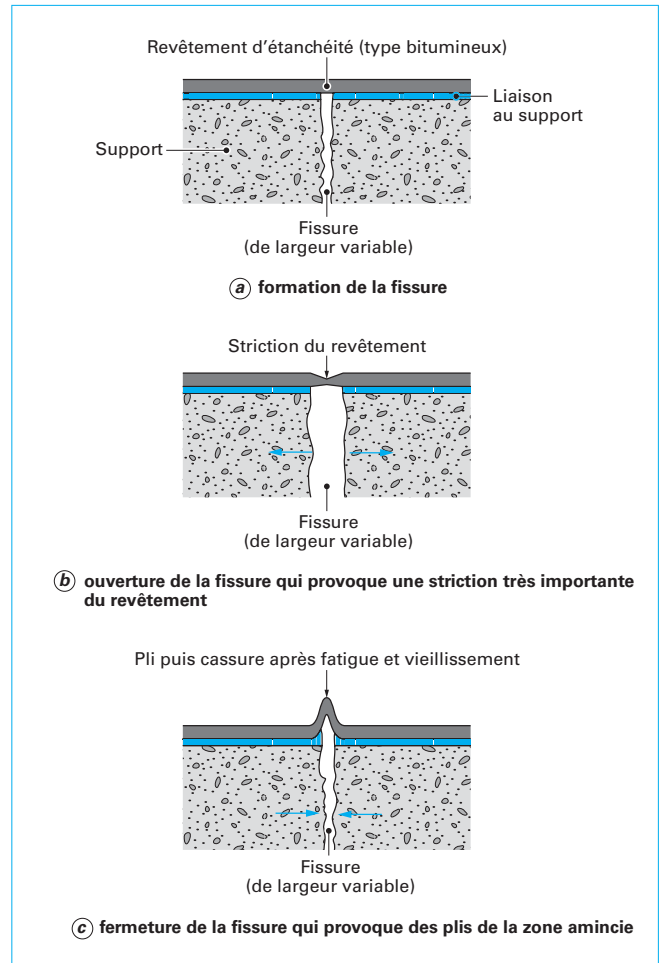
Fonctionnement d'un revêtement à reprise élastique insuffisante (asphalte, bitume) au droit d'une fissure
